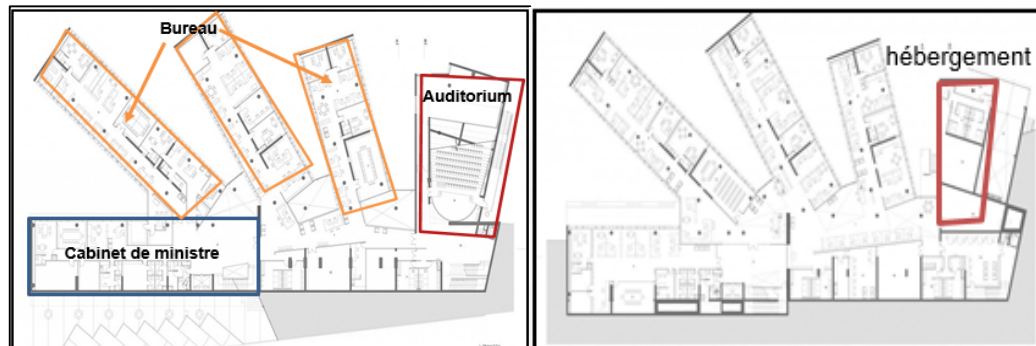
plan de 2 eme étage (archidaily.com) Figure 57: plan de 3 eme étage(archidaily.com)
